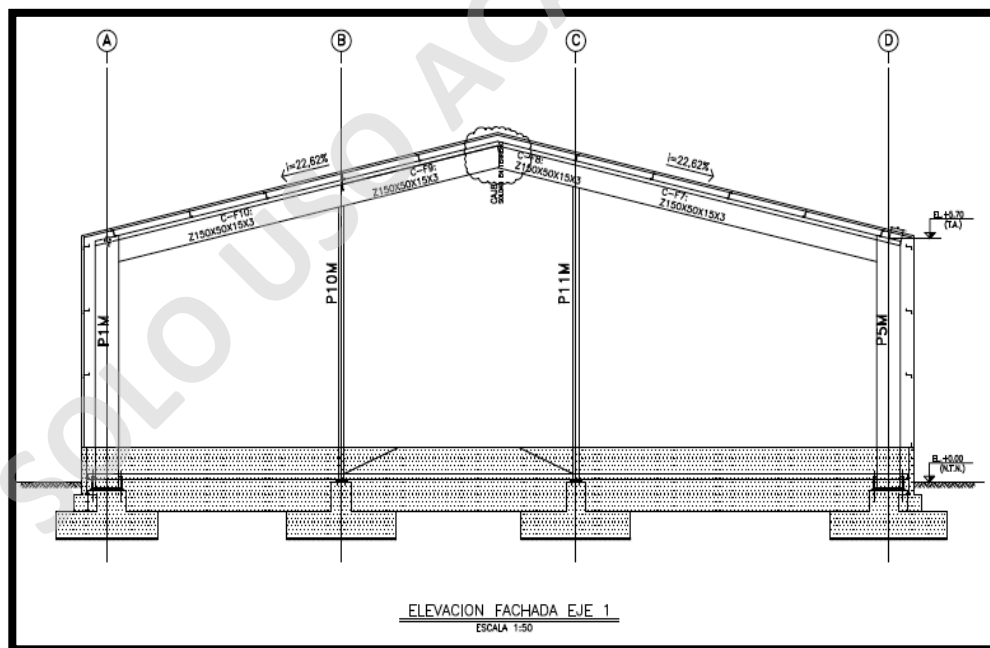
Planos de Montaje ODR Ingeniería y Montajes
